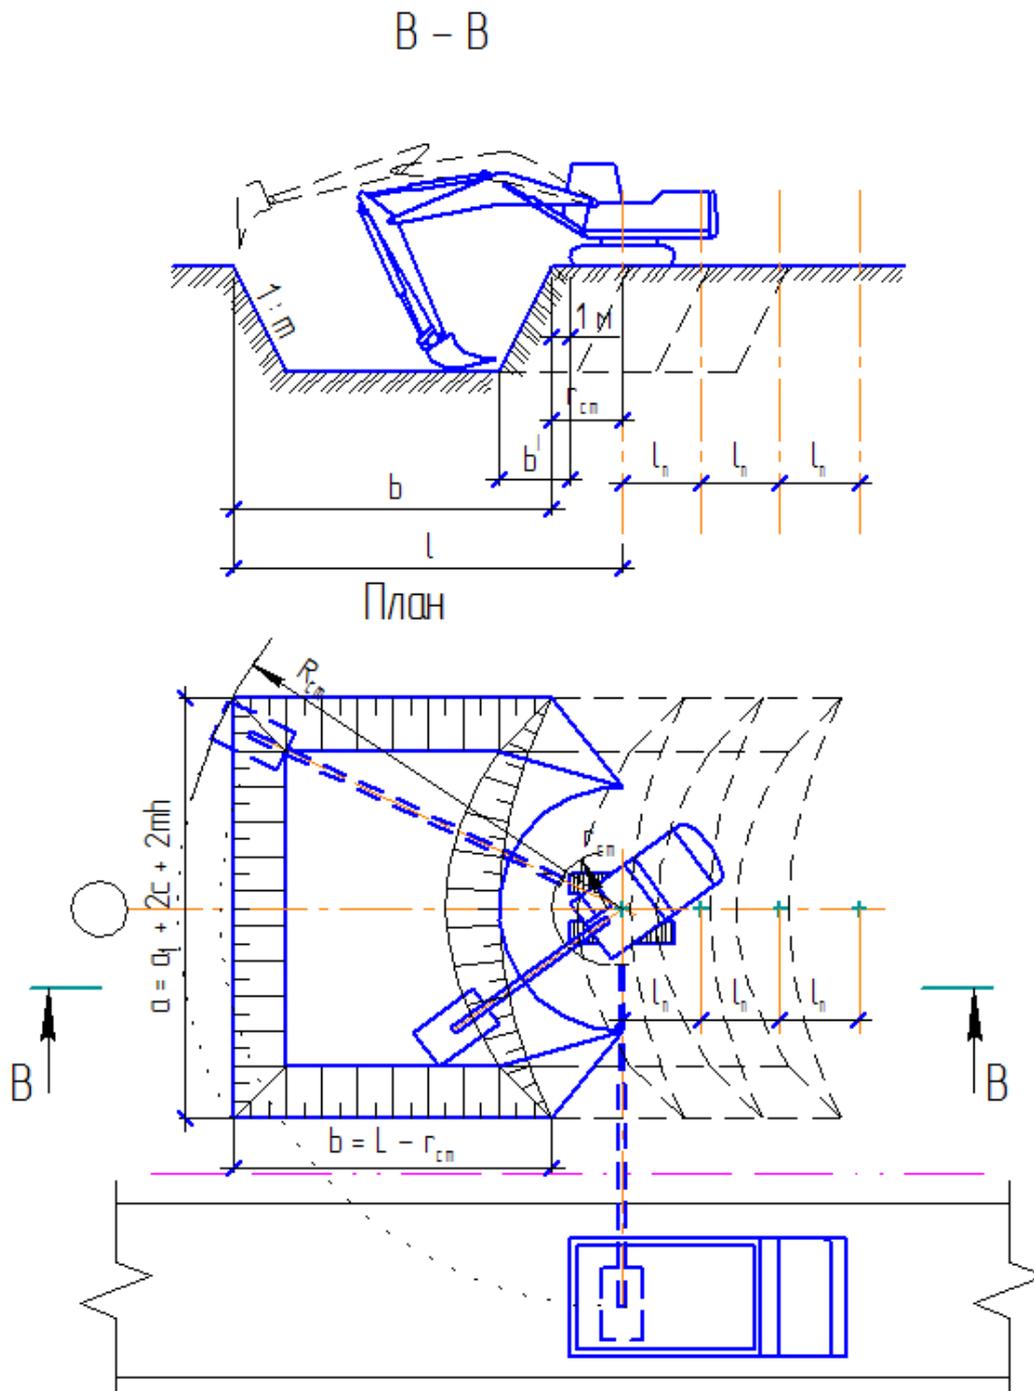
Схема разработки котлована под один фундамент с нескольких стоянок
